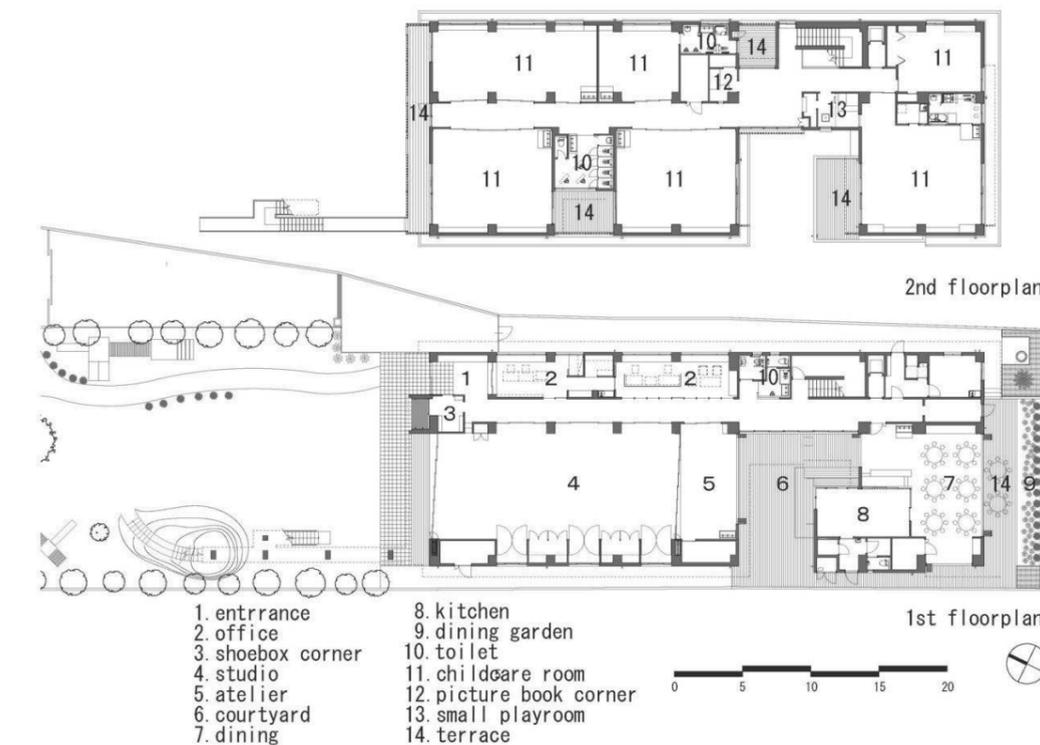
Plantas baixa do pavimento térreo e superior do Jardim de Infância Hanazon. Fonte: Archdaily Brasil.
